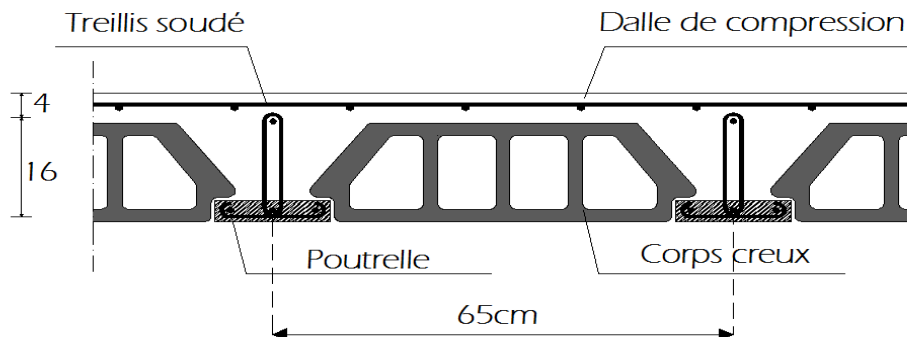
1: Coupe transversale d'un plancher en corps creux.
